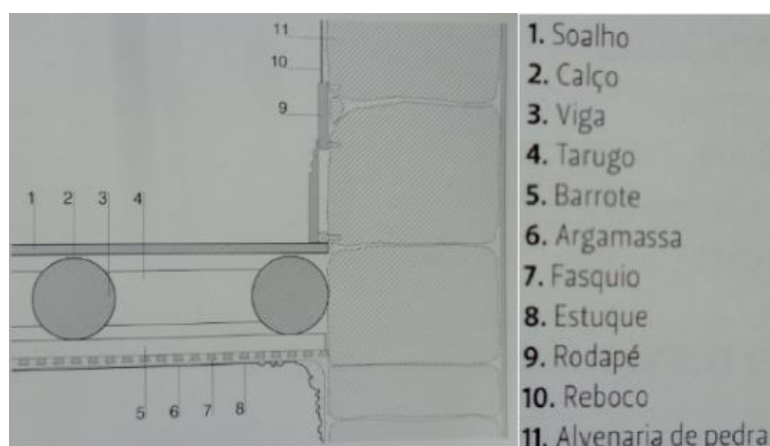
Pormenor construtivo do pavimento de madeira / parede exterior [6]
